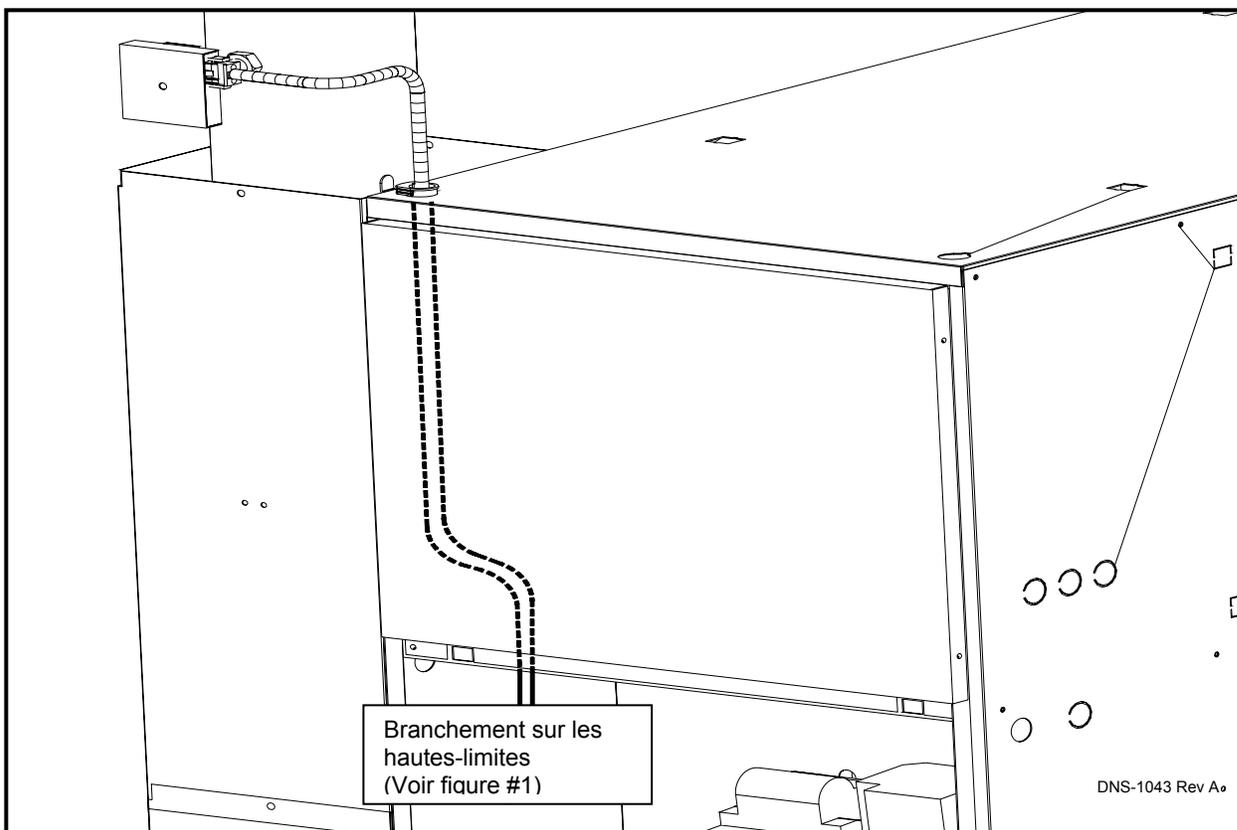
Arrangement général du système anti-refoulement, installation en débit descendant
